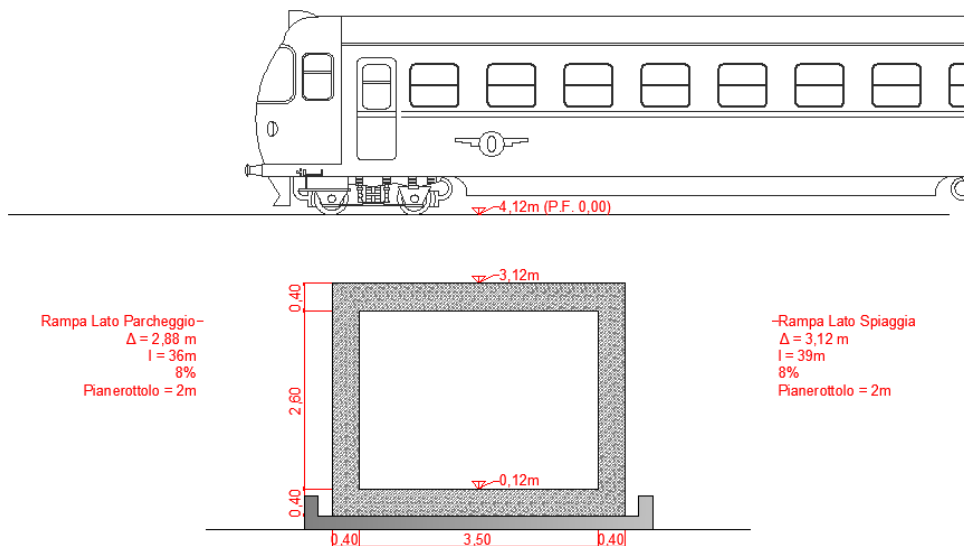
Sezione dello scatolare e calcolo preliminare delle rampe d'accesso del sottopassaggio ciclabile
